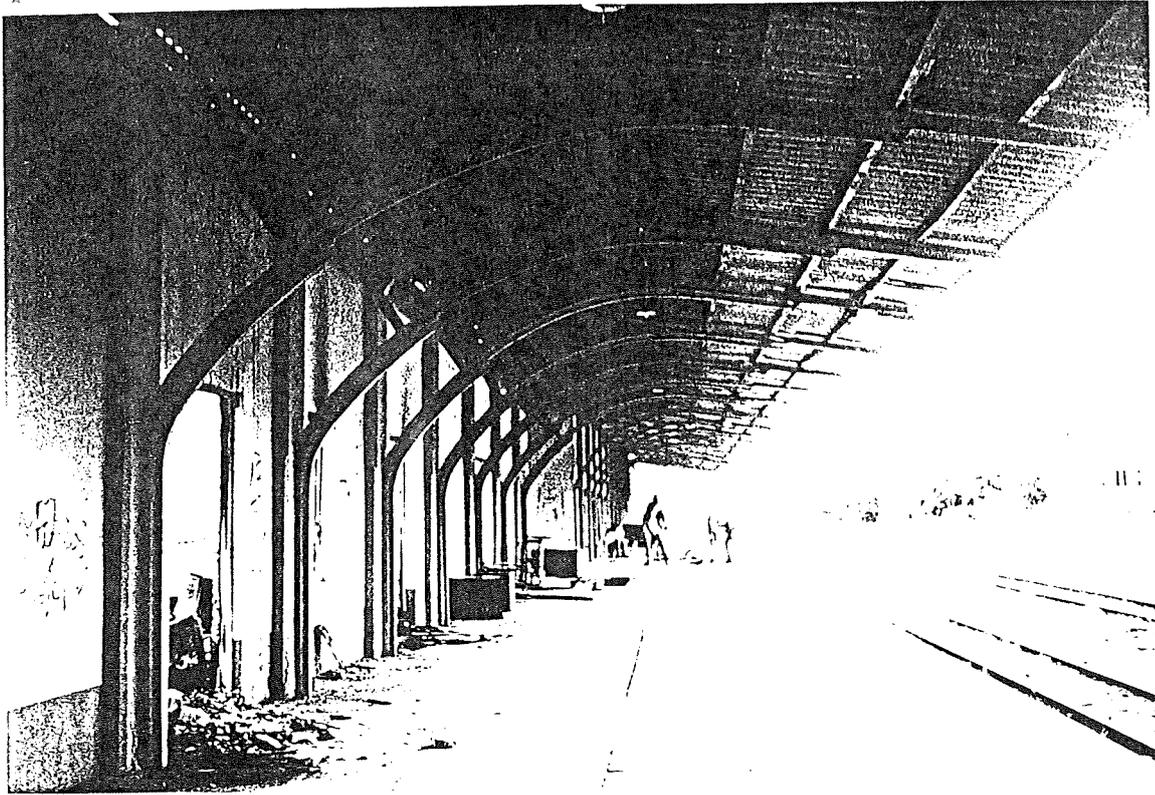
Vista geral do conjunto da Plataforma de Embarque
